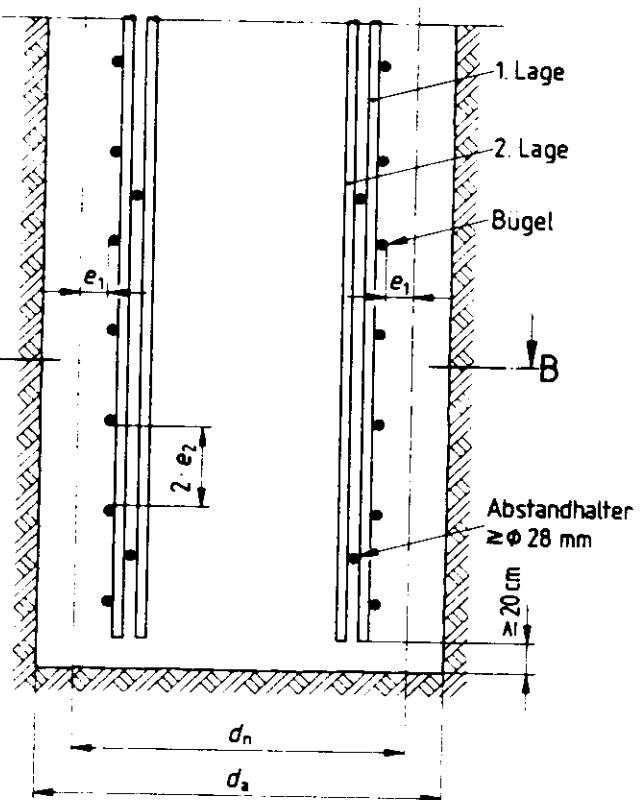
Durchflußweite zur Sicherung der Betondeckung und Bewehrungsanordnung
